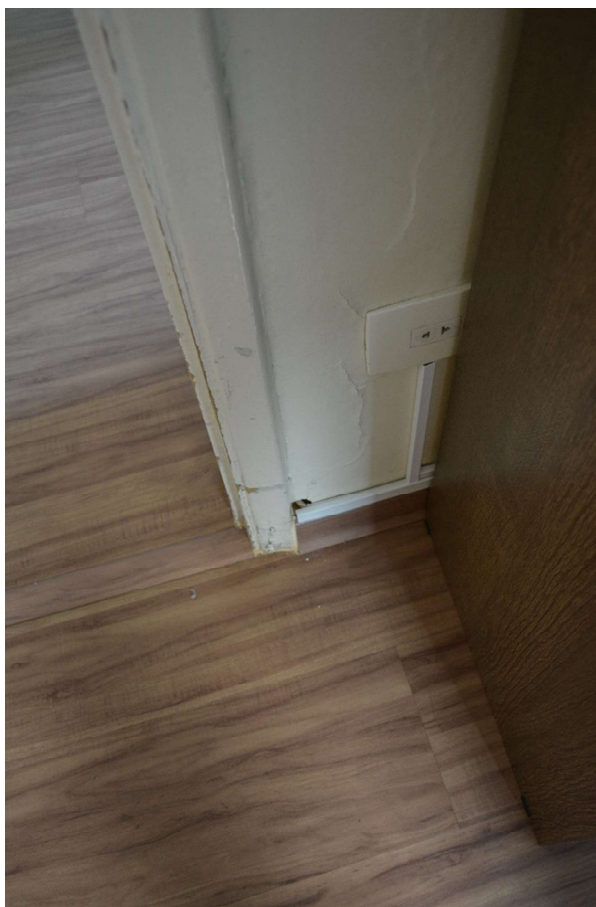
FISSURAS NA PORTA DE ENTRADA E DERIVAÇÃO EXTERNA DE ENERGIA NA PORTA DO DORMITÓRIO 1, PADRÃO DE TOMADAS ANTIGO.
